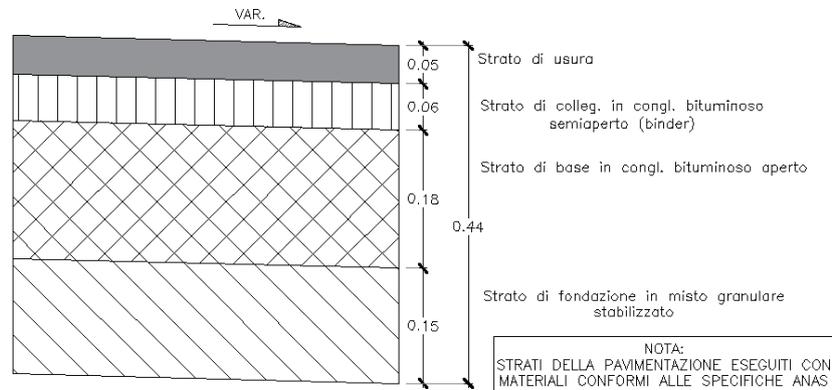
Dettaglio di pavimentazione dell'arteria principale e della viabilità in affiancamento
